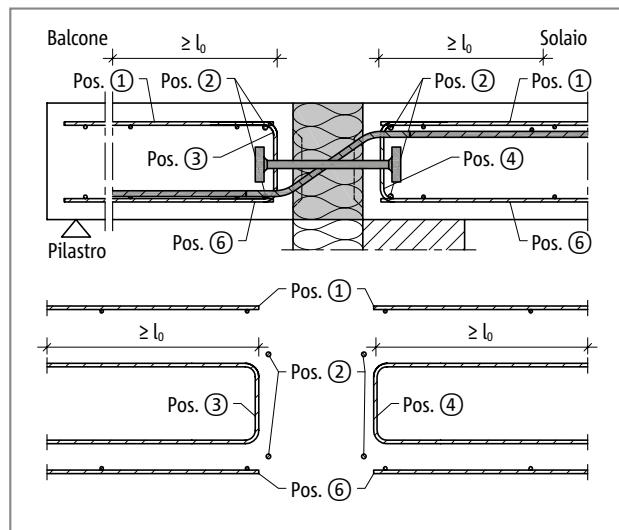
Schöck Isokorb® tipo QPXT: armatura in opera
